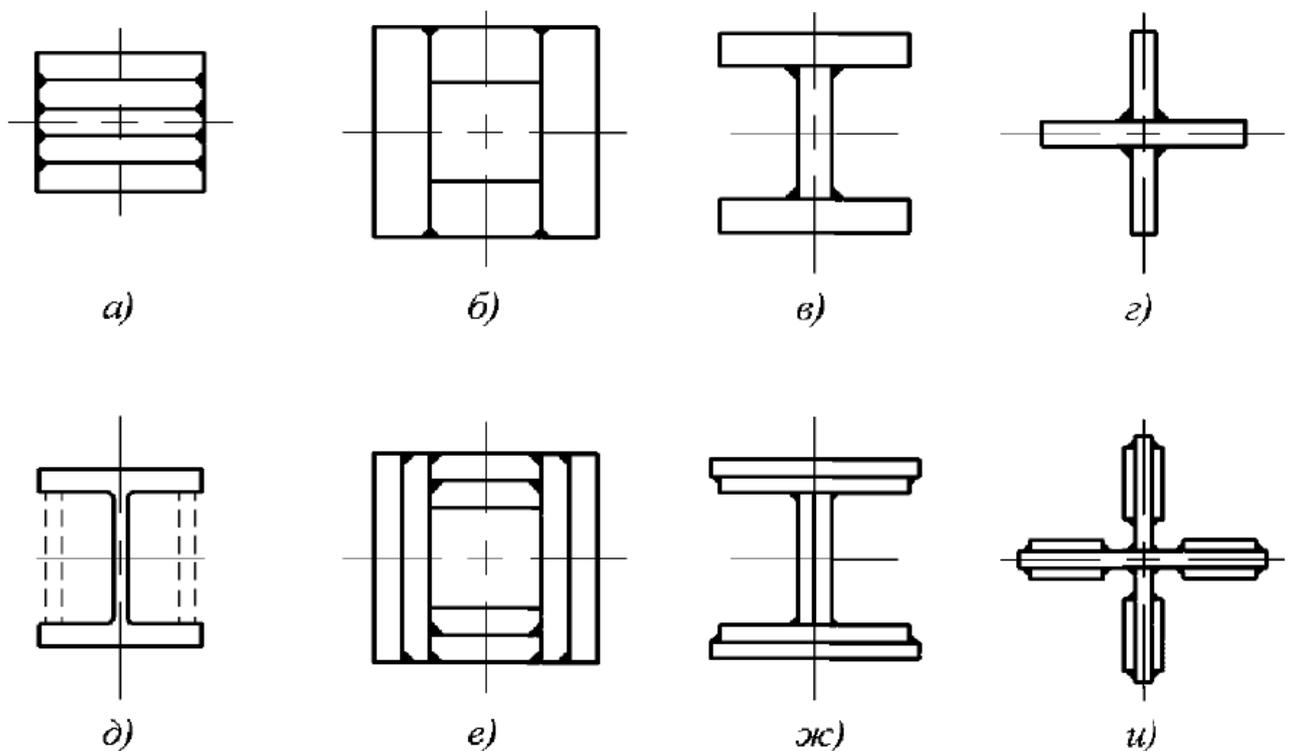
Поперечные сечения колонн для многоэтажных зданий
